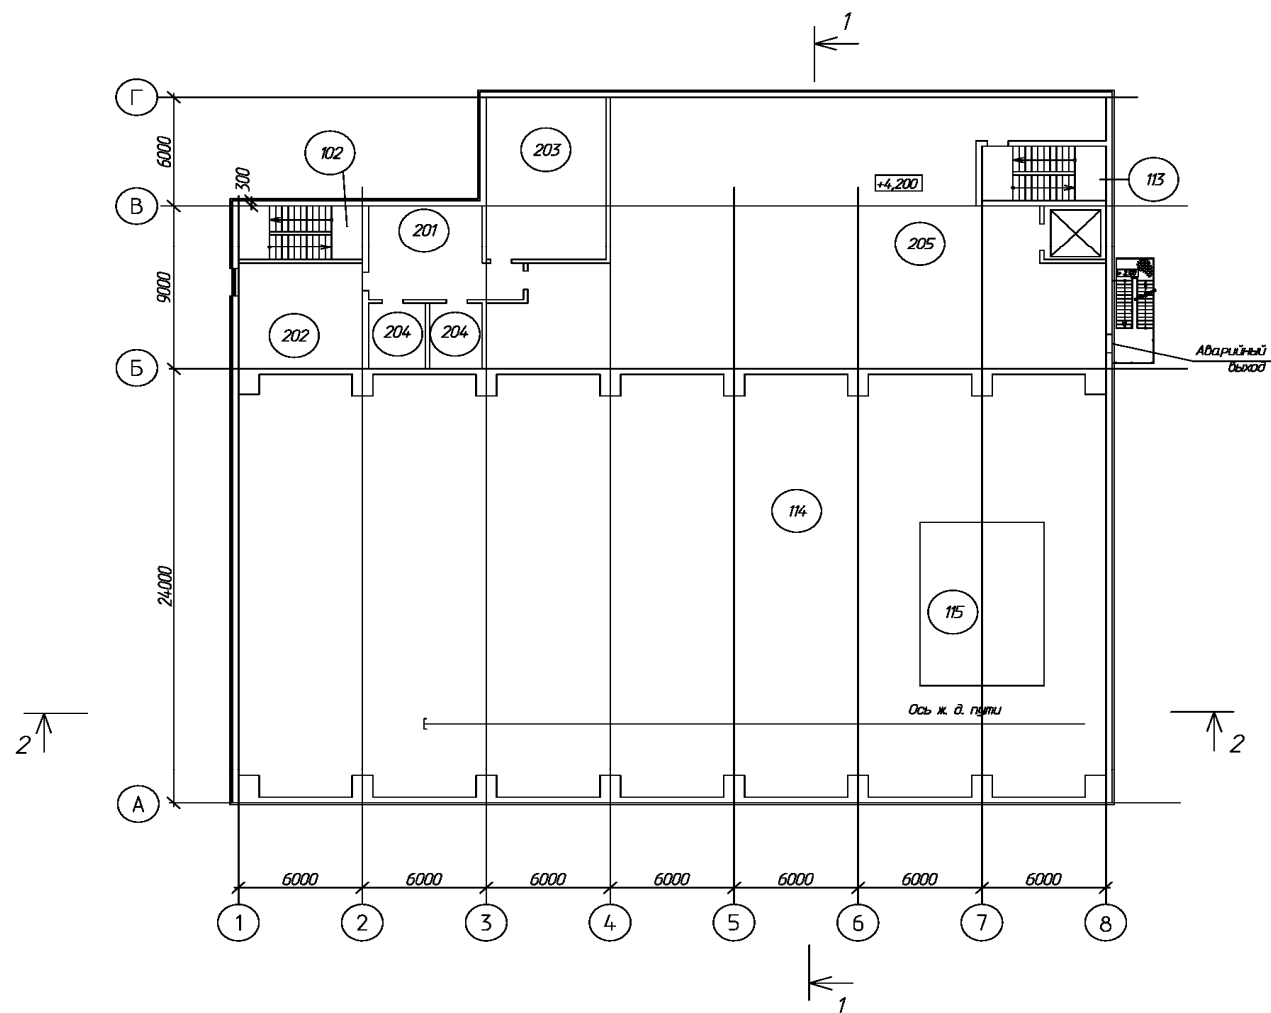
Здание приемки. План на отметке 4,200
